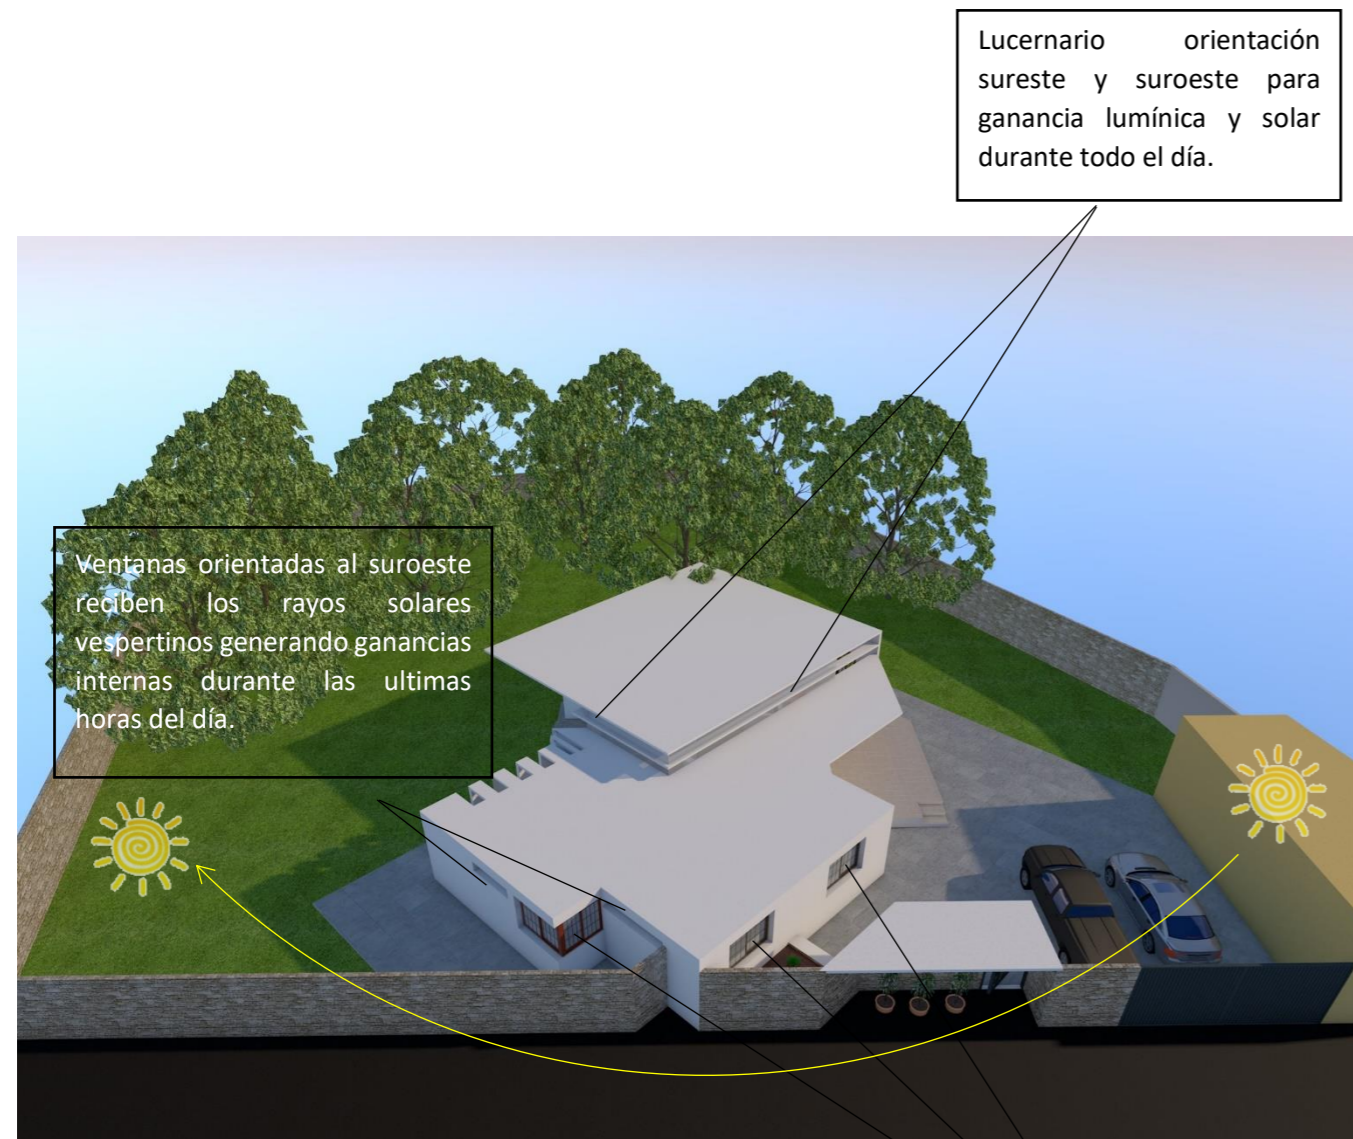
ubicación de ventanas en fachada sureste y suroeste (propia, Elaboración)
